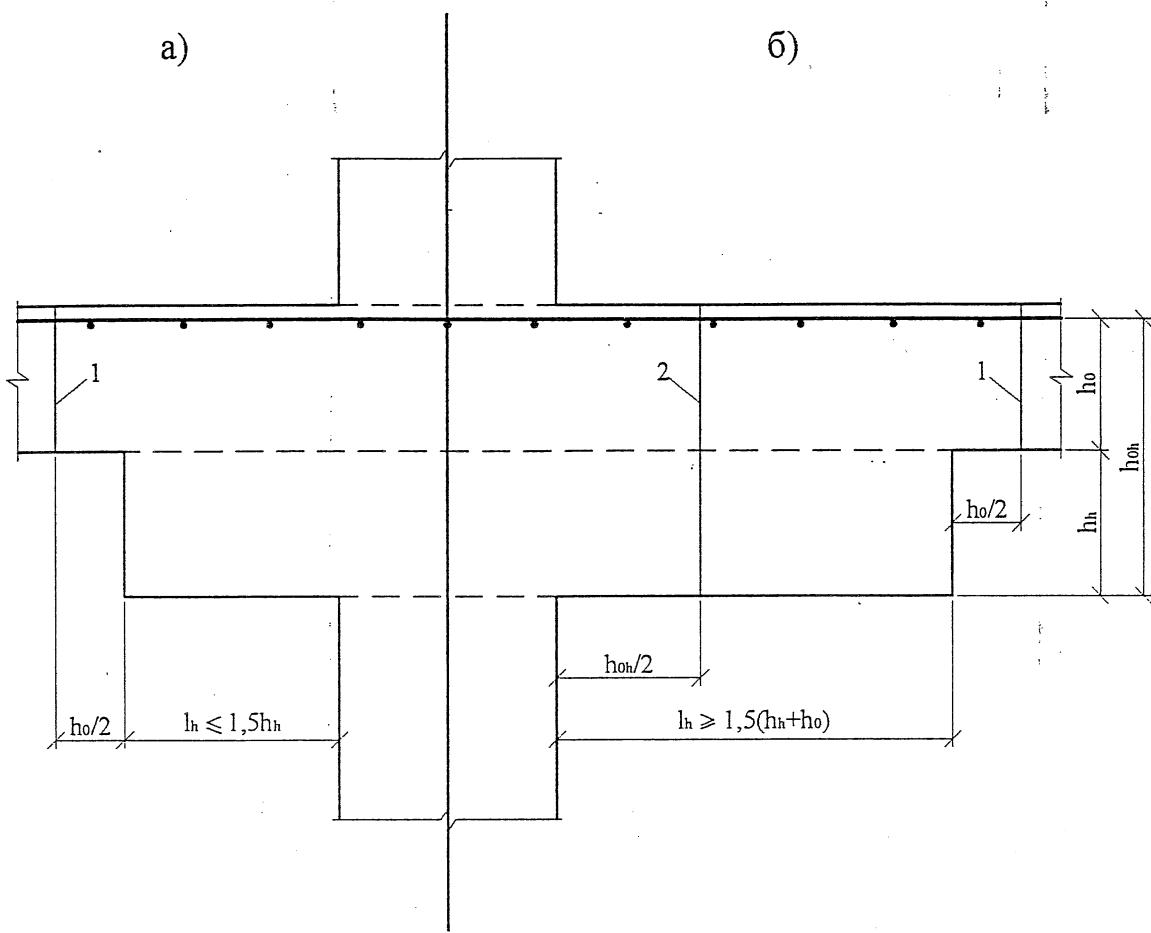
Схемы для расчета железобетонных плит на продавливание при наличии капителей
